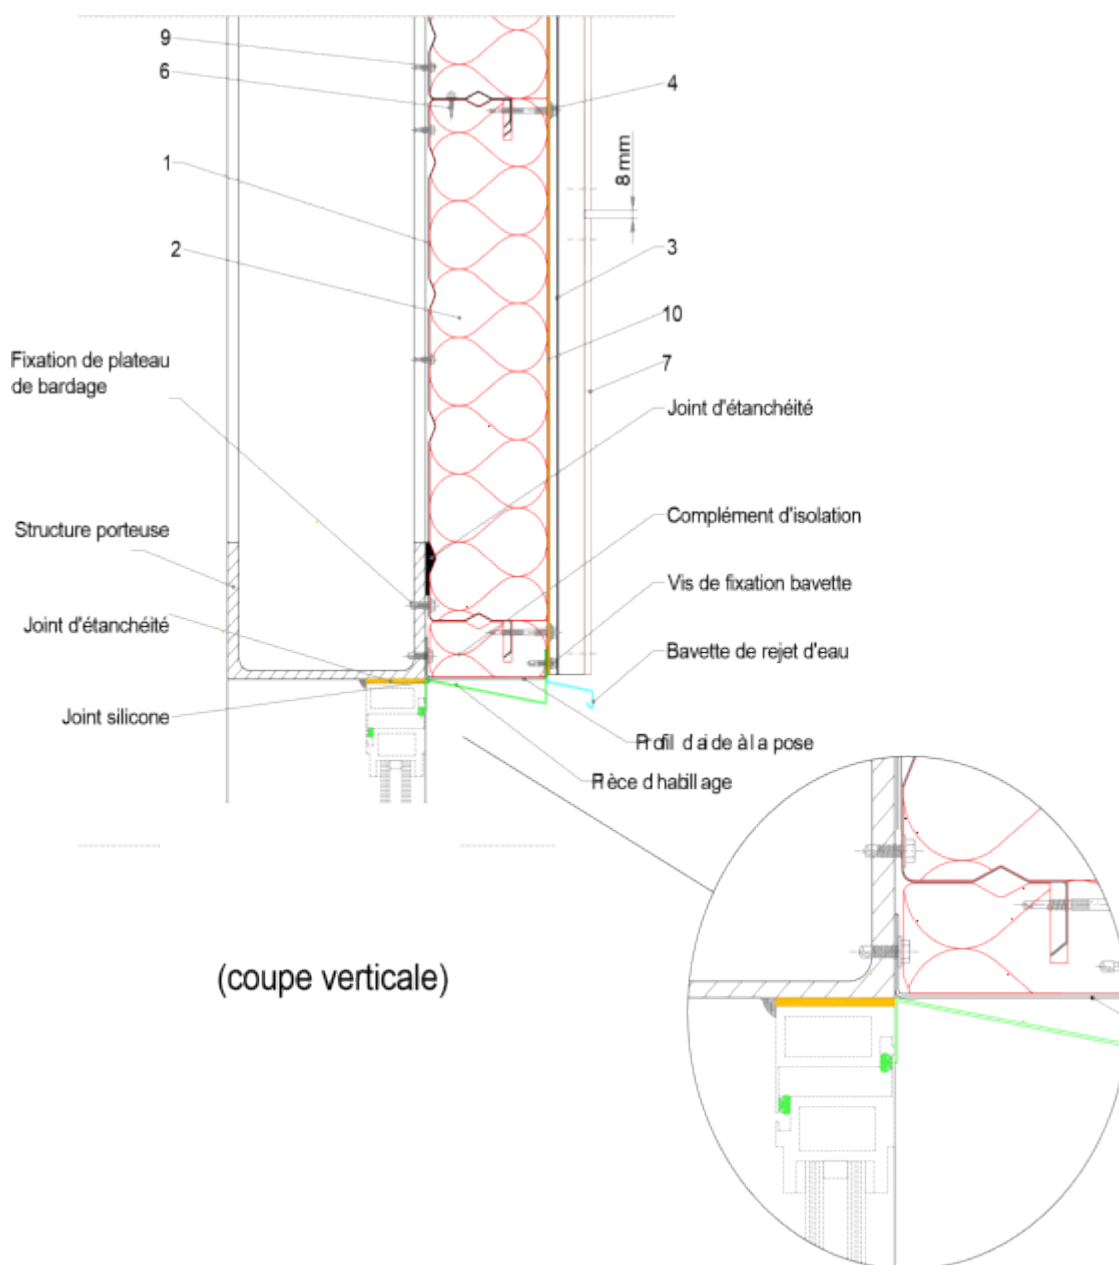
Linteau de baie – Coupe verticale avec PANNEAU EQUITONE
